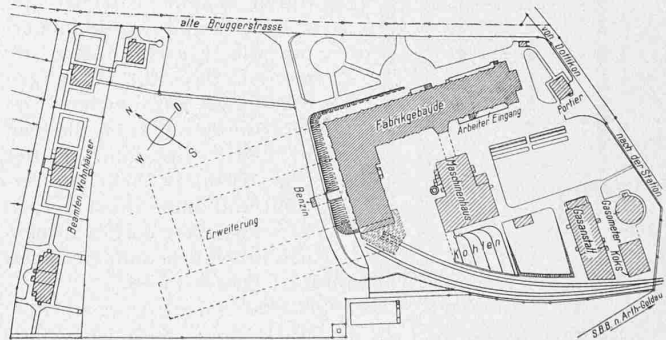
Lageplan der Fabrikanlage. — Masstab 1:3000.
